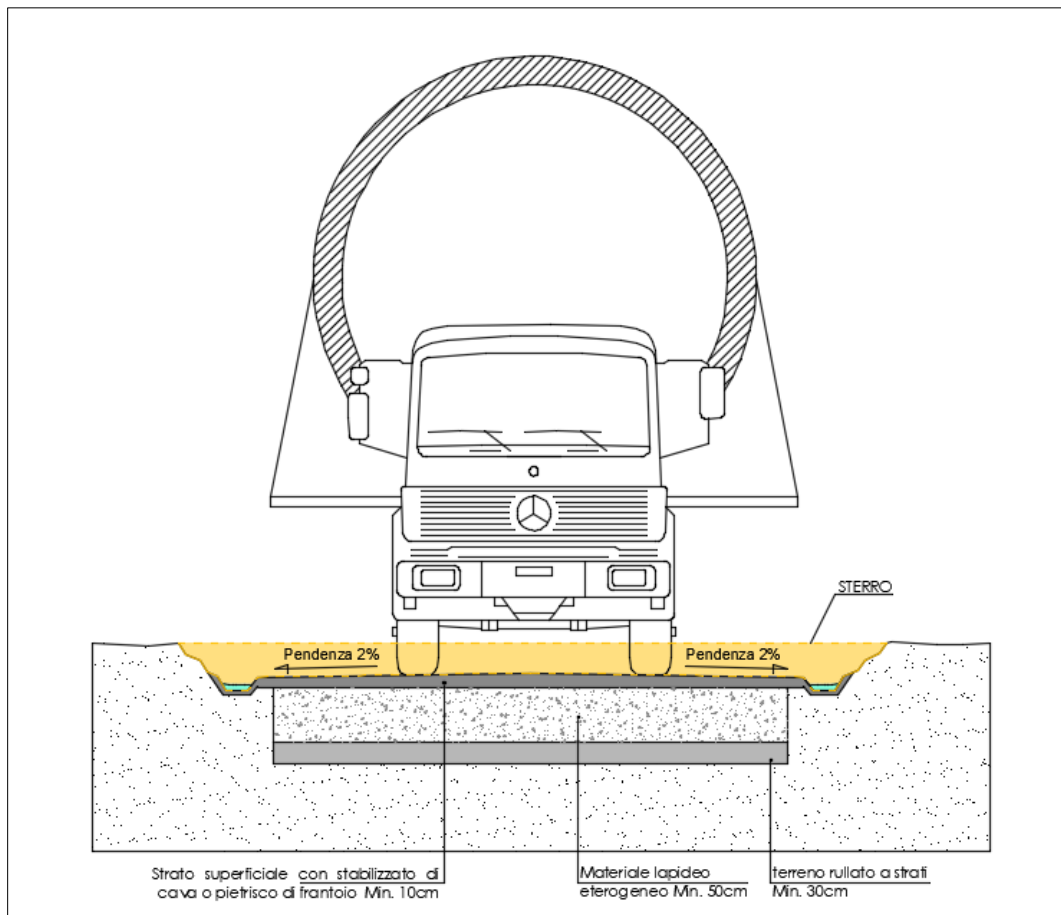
Sezione stradale tipo di nuova realizzazione in trincea
